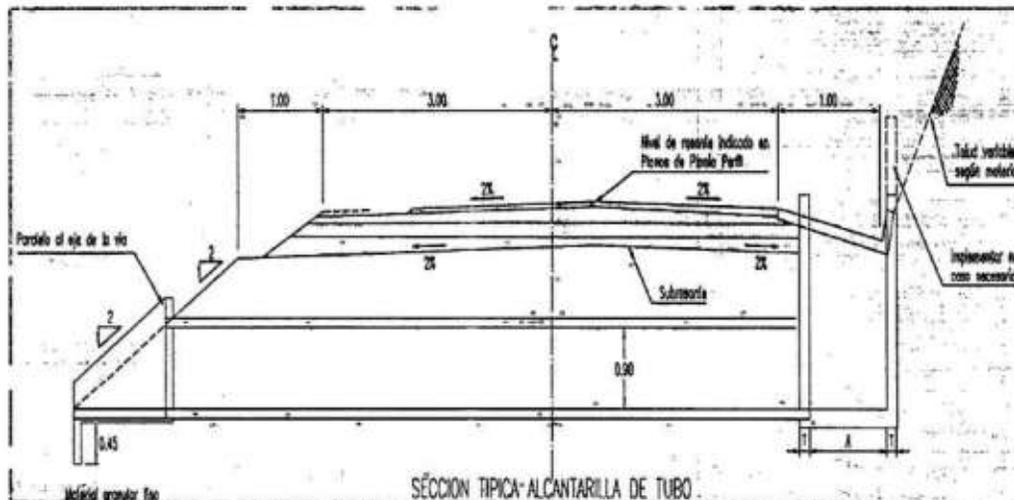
Sección típica longitudinal de alcantarilla circular de 36" en Tramo Vial Gimai – Minas de Iracal.
